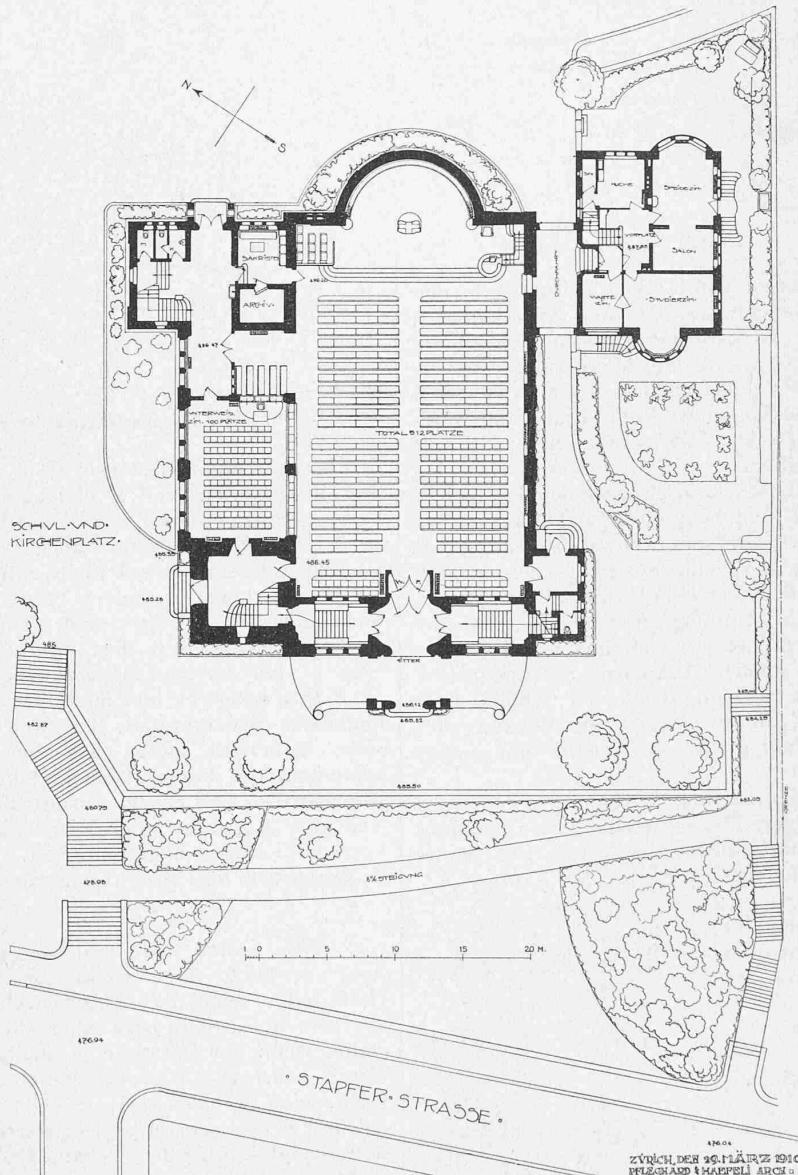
Erdgeschoß-Grundriss von Kirche und Pfarrhaus, nebst Umgebung.
